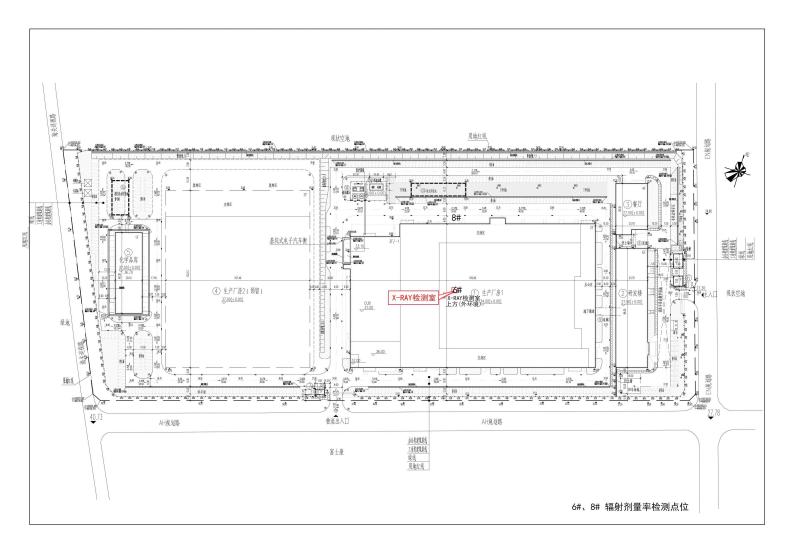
联测优特半导体(烟台)有限公司总平面布置示意图
